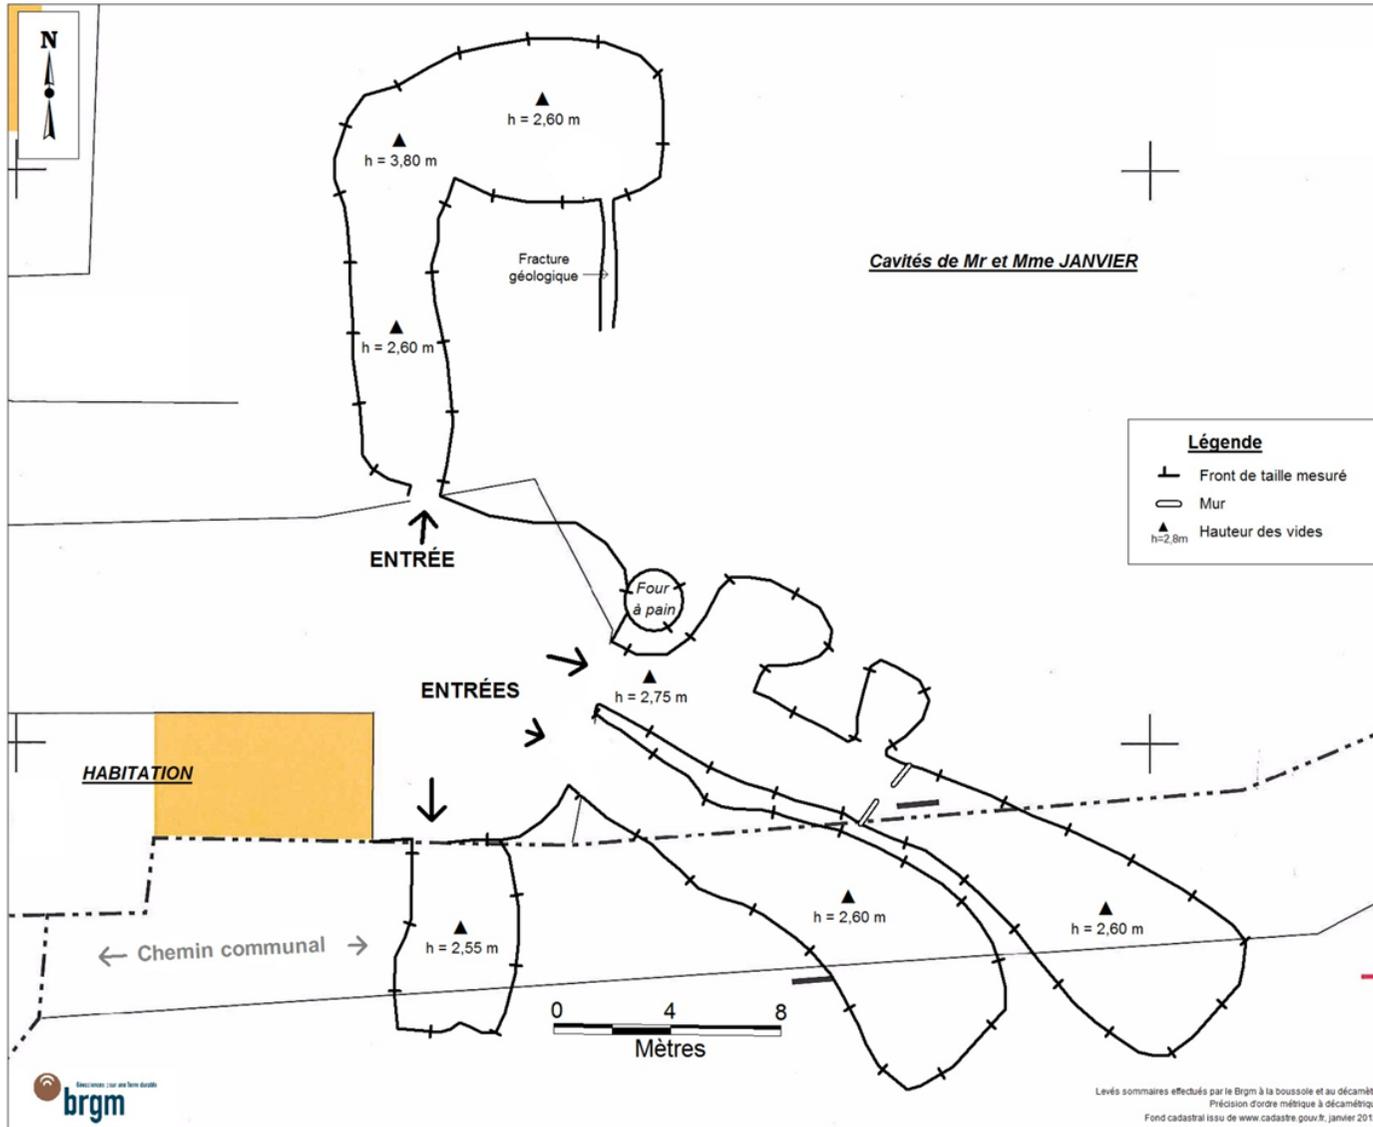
Emprise des cavités de Mr et Mme Janvier sur fond cadastral
